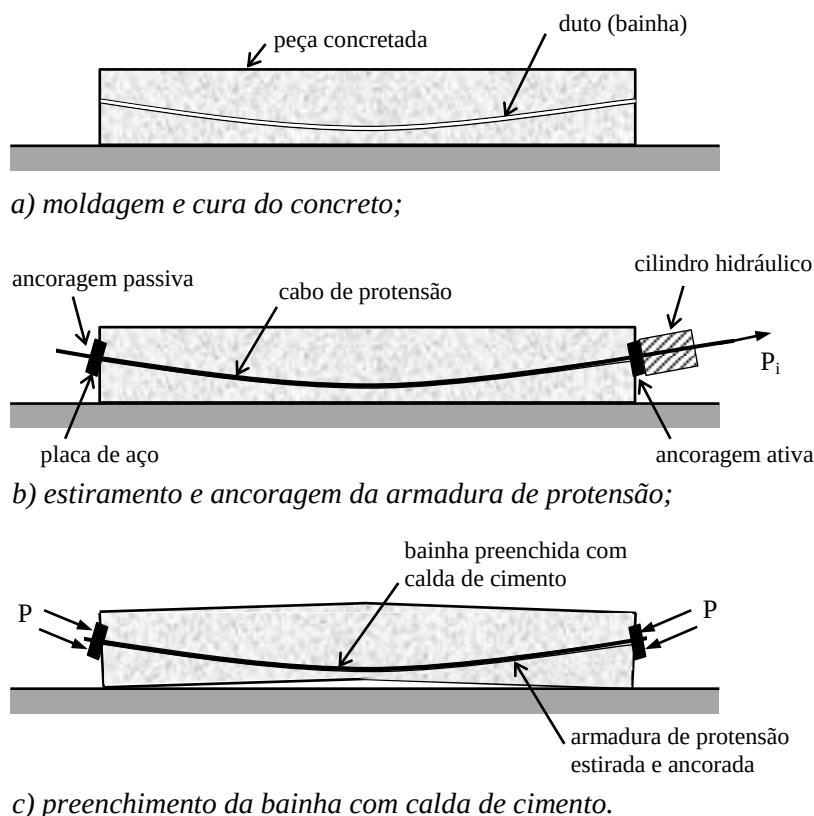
Esquema simplificado de fabricação de viga protendida com pós-tensão.
